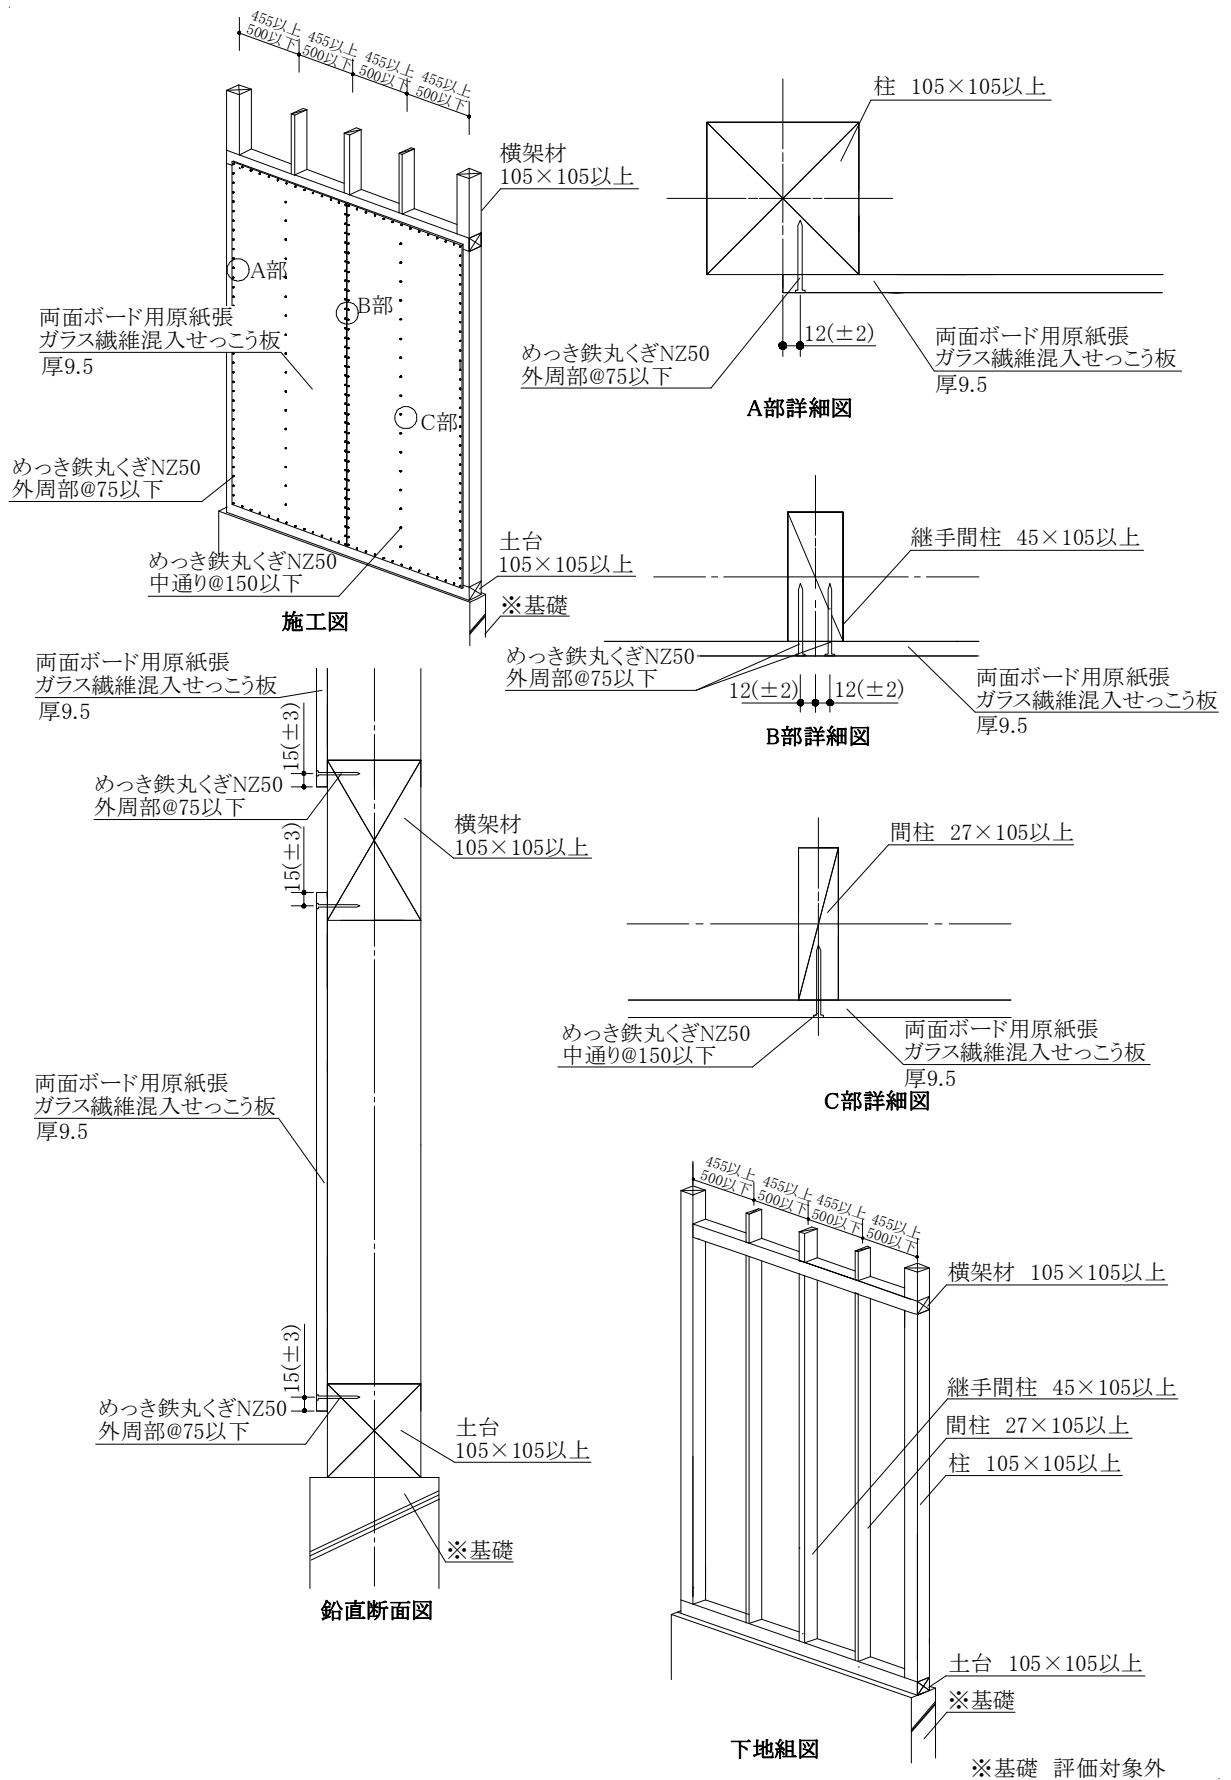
施工詳細図：1枚張りの場合（寸法単位：mm）
